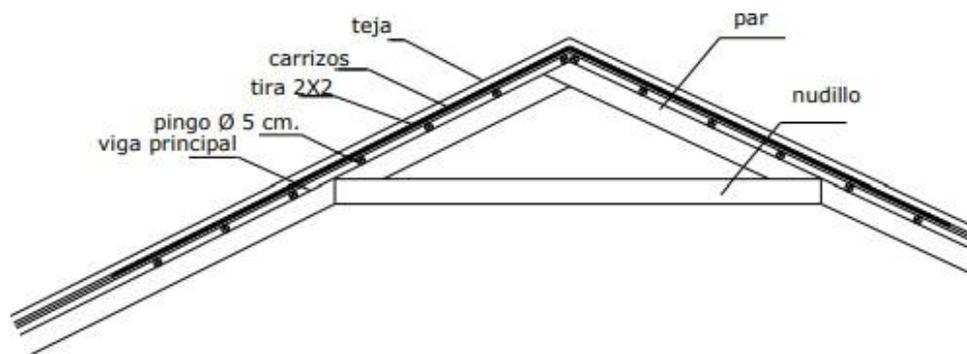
Estructura de madera para cubierta nueva con sistema de par y nudillo.
